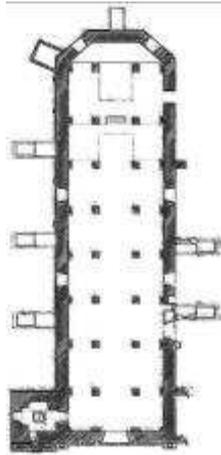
Planta Arquitectónica del Templo de Tiripetío Michoacán, México.
